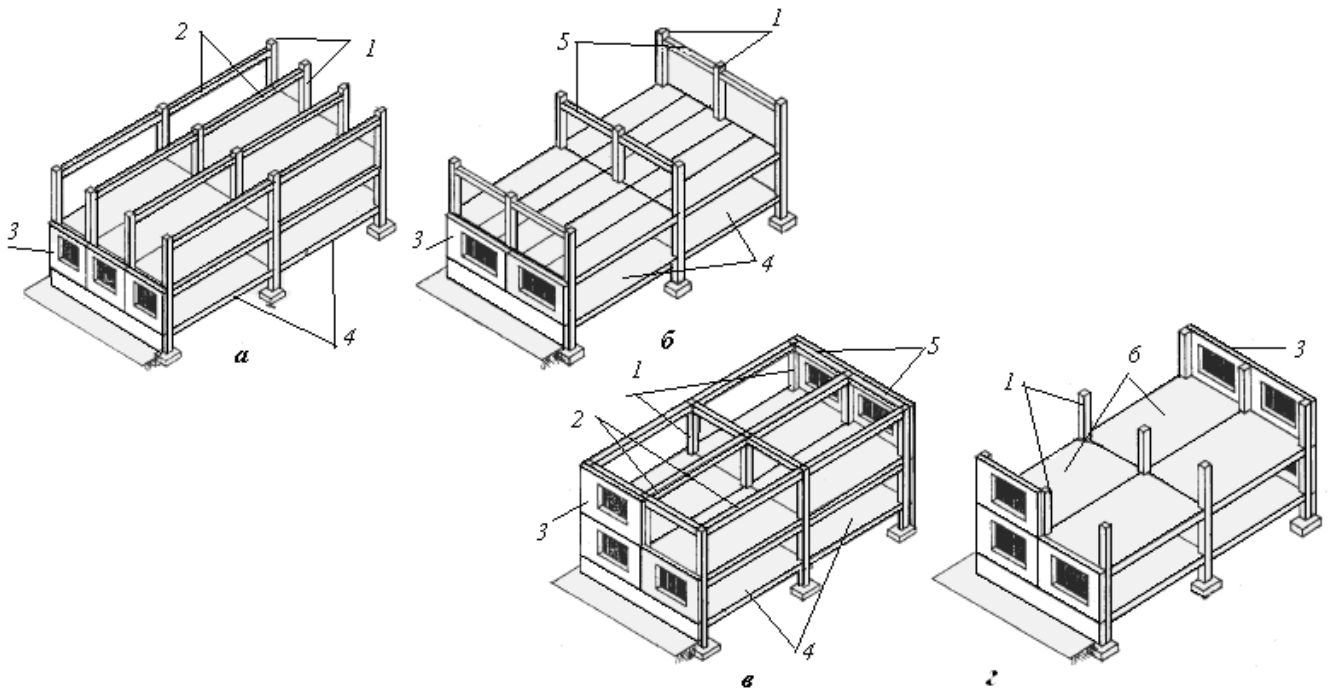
Конструктивні схеми каркасних будівель: а – з поперечним розташуванням ригелів; б – з поздовжнім розташуванням ригелів; в – з перехресним розташуванням ригелів; г – безригельна. 1 – колони; 2 – ригелі; 3 – самонесучі стіни; 4 – плити міжповерхового перекриття; 5 – повздовжній ригель; 6 – між колонні плити перекриття
